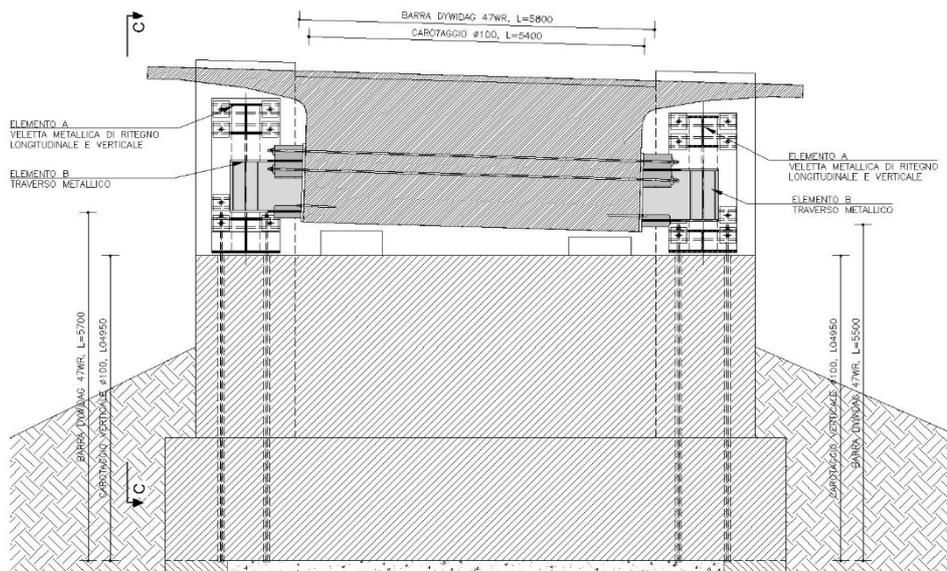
Spalla Sp.1 - Sezione trasversale in asse appoggi
